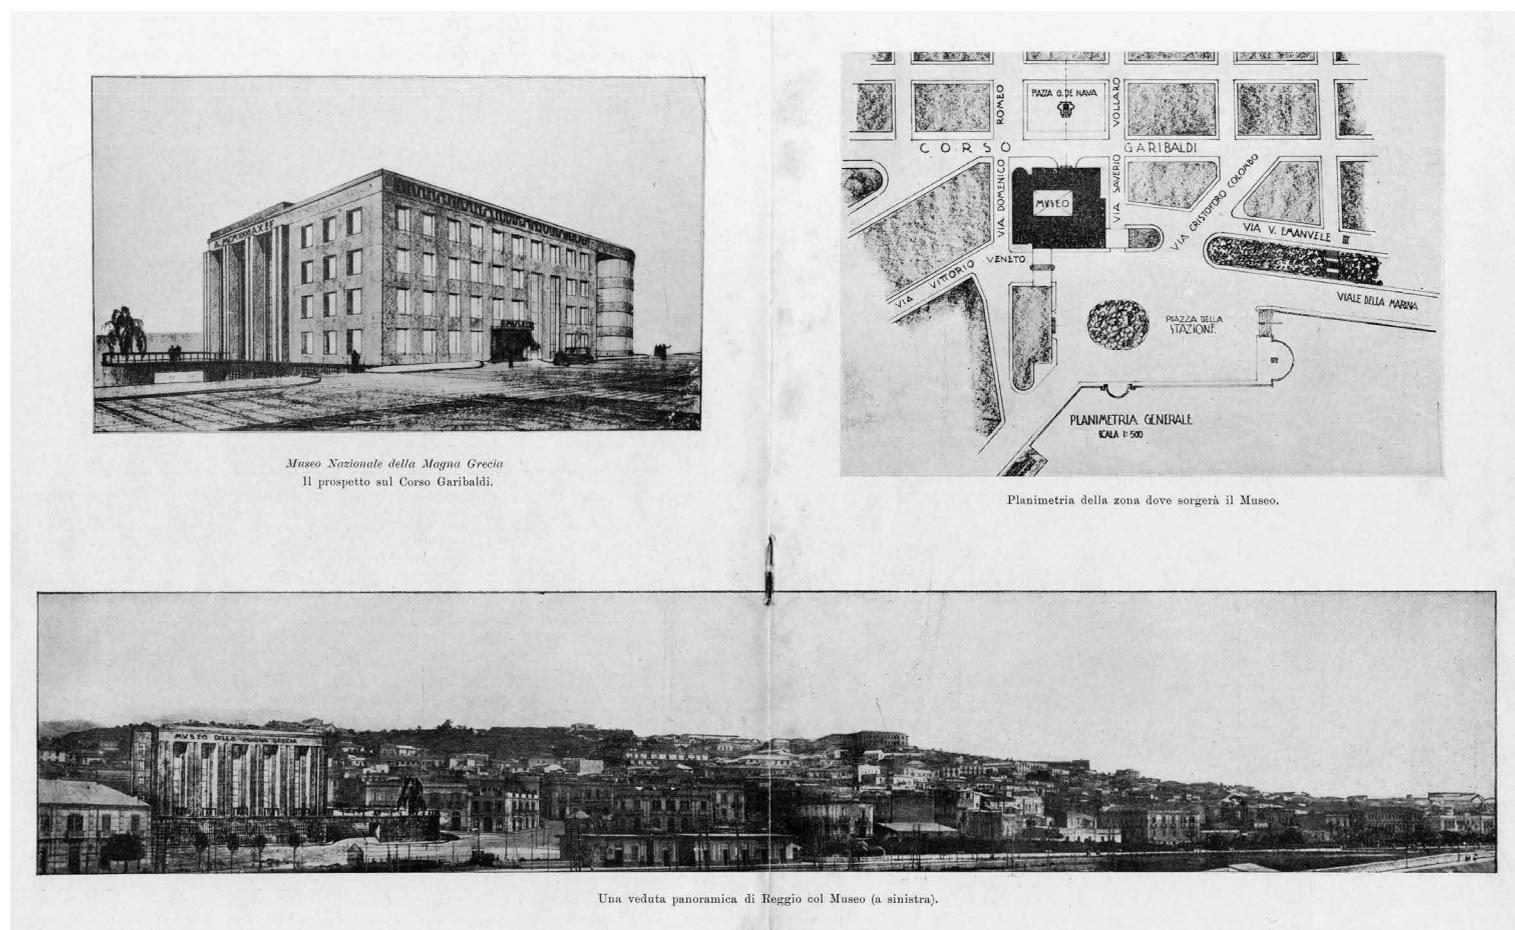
M. Piacentini, *Vista prospettica, planimetria generale e fotomontaggio panoramico del progetto iniziale del museo* (da *Il Museo Nazionale della Magna Grecia...* cit., pp. 12-13).
